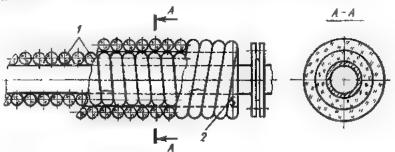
Изоляция трубопроводов шнурами: 1 — шнур. 2 — проводочное кольцо
